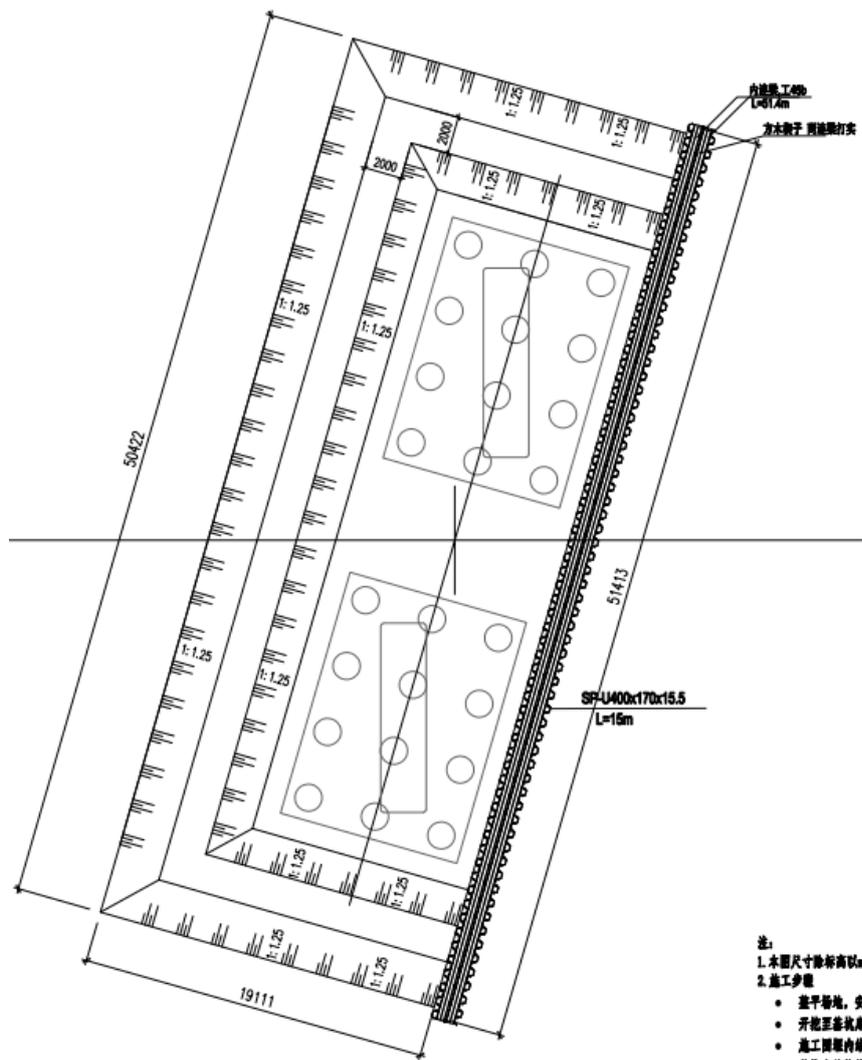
单侧钢板桩围堰支撑平面图
